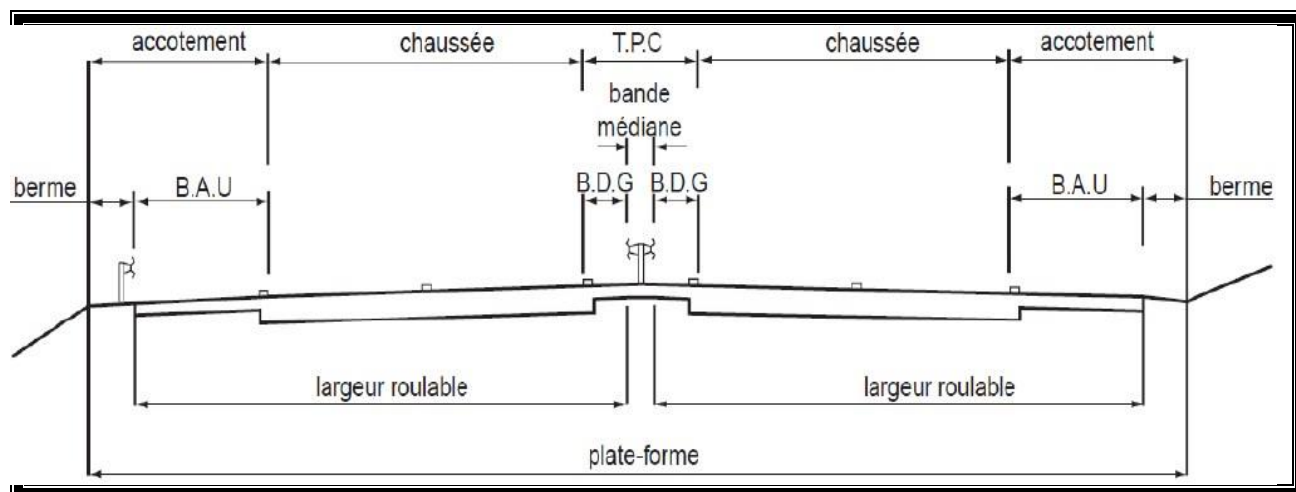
Eléments du profil en travers en 2x2 voies en section courante
